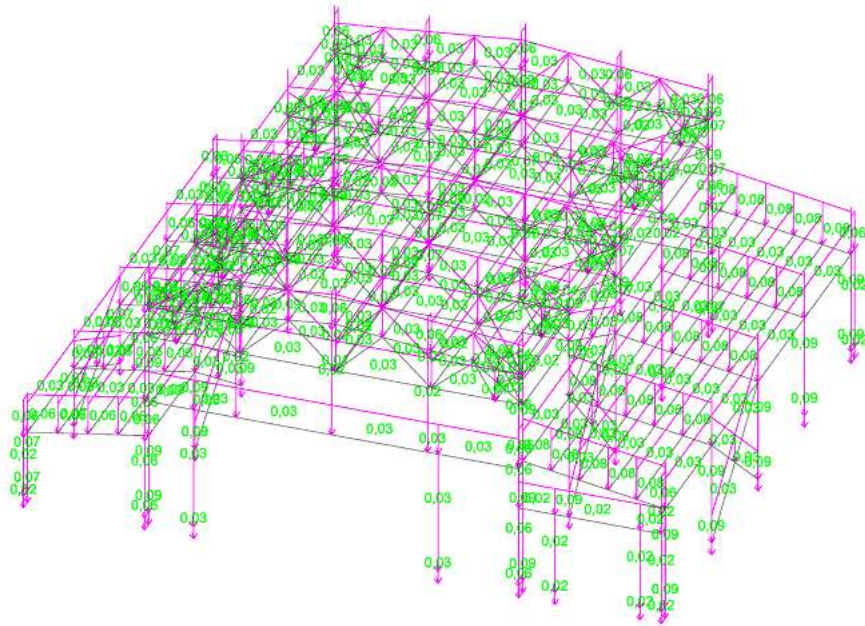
Схема загрузки постоянной нагрузкой от собственного веса металлических конструкций
